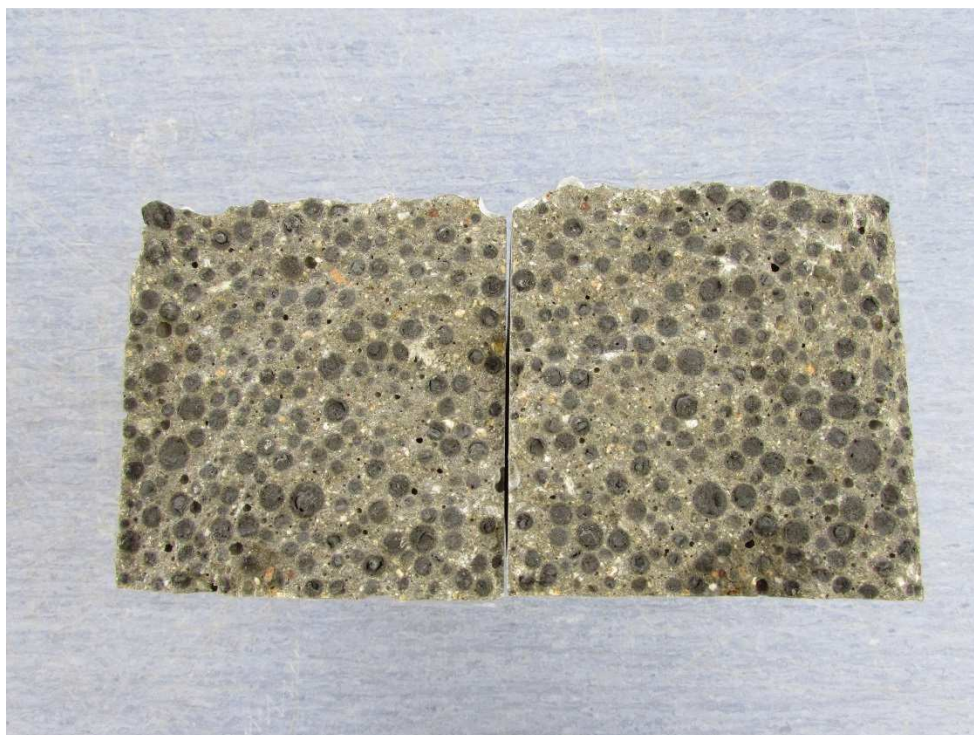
Tělesa z betonu 2 těsně po betonáži
